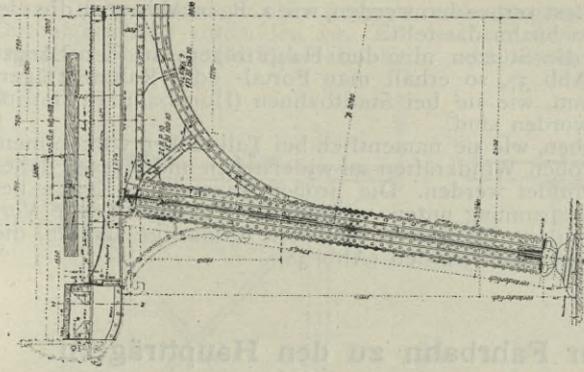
Uebersicht eines Kragträgers der Berliner Hochbahn.
